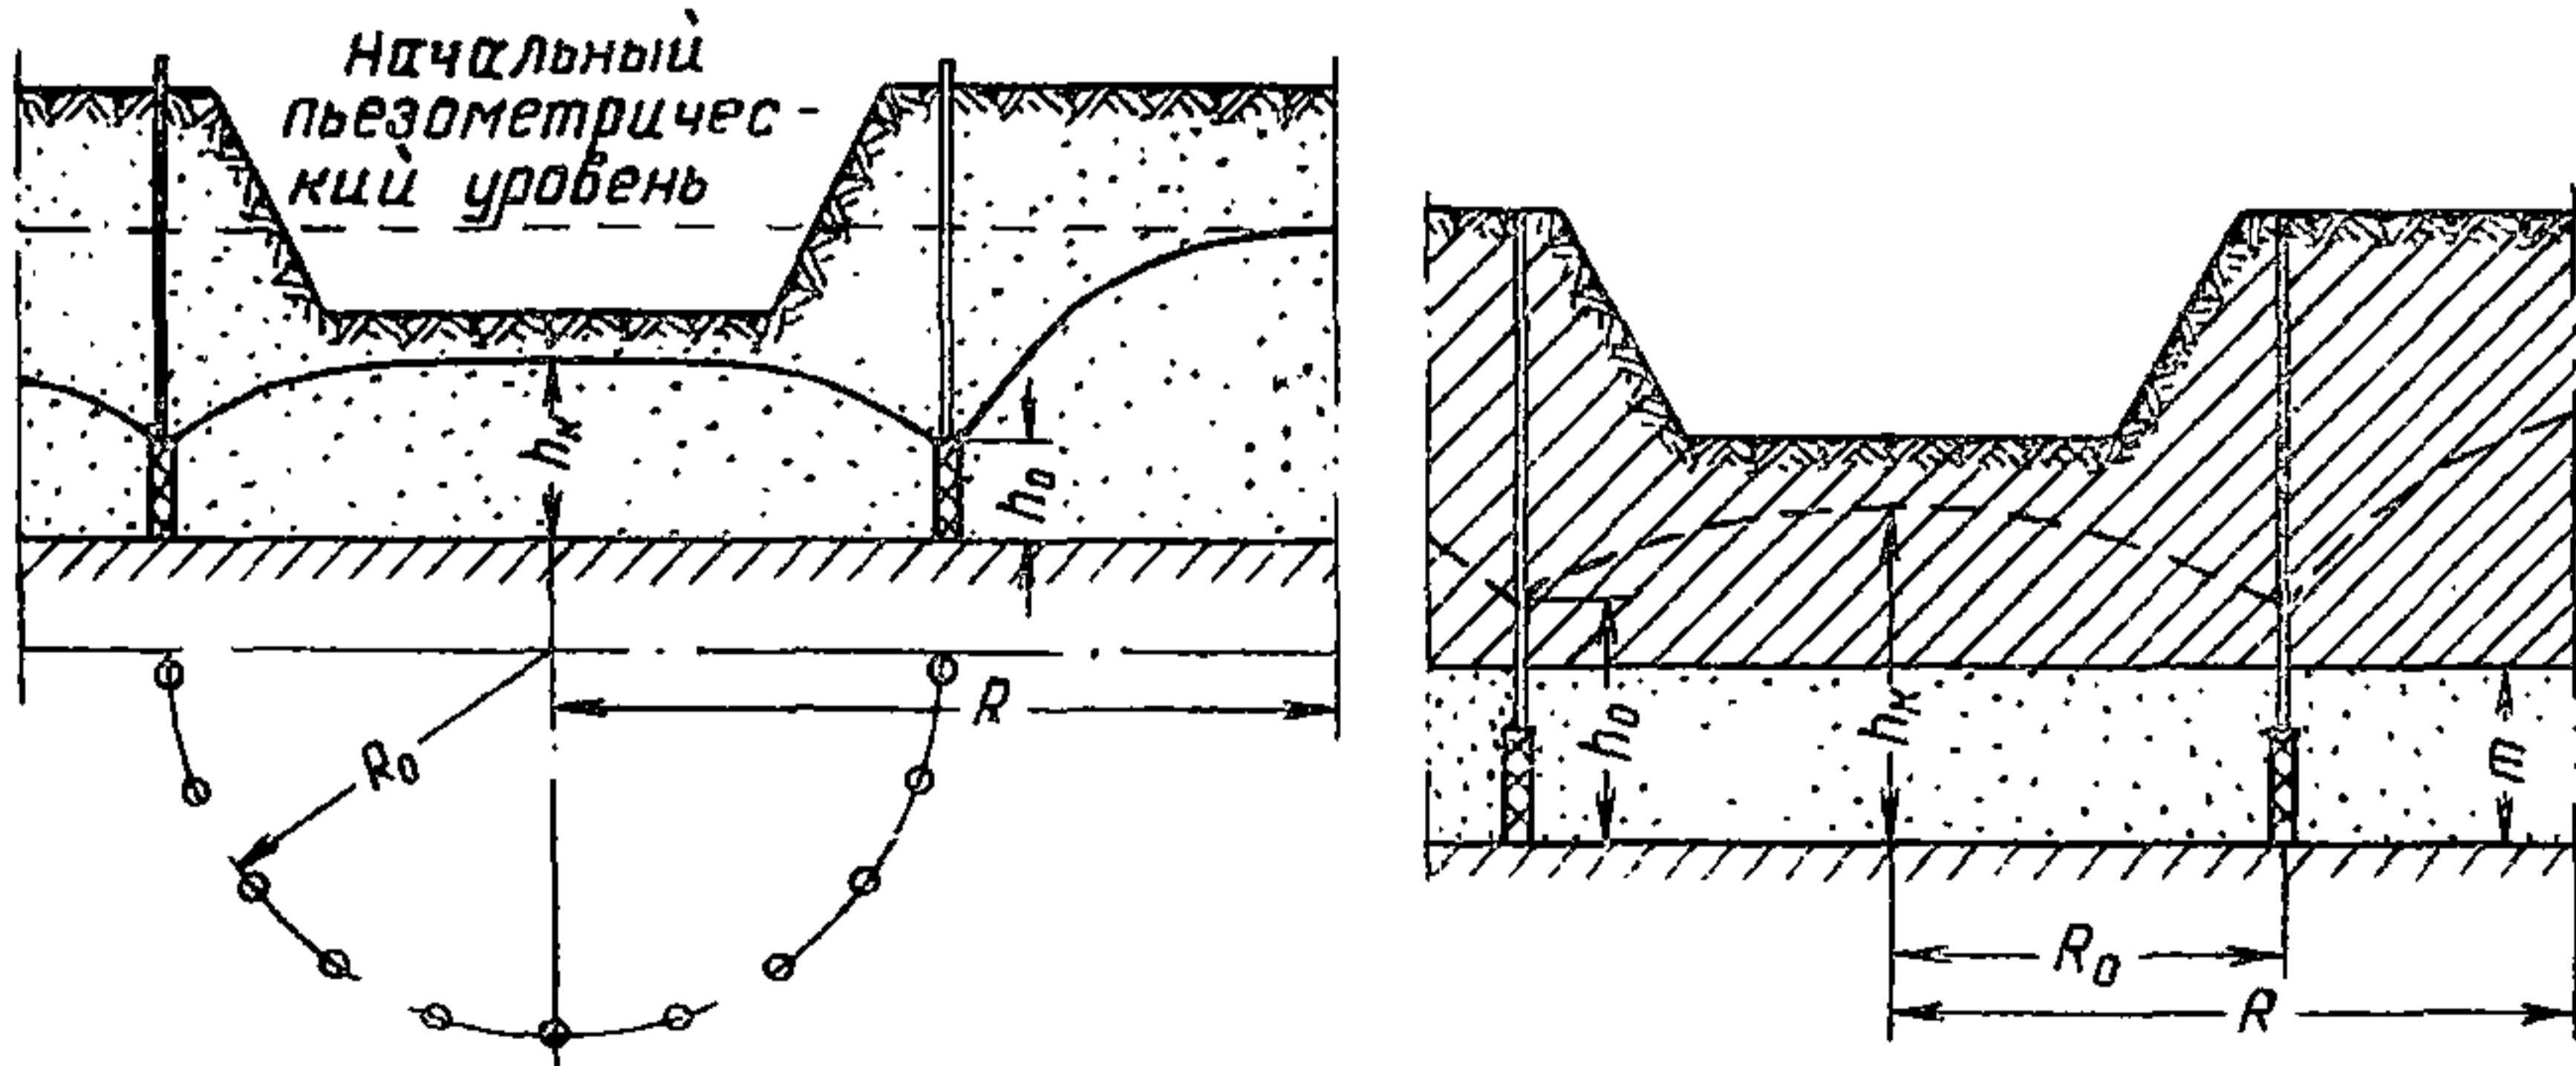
Схема водопонижения при разработке котлована в безнапорных водах
